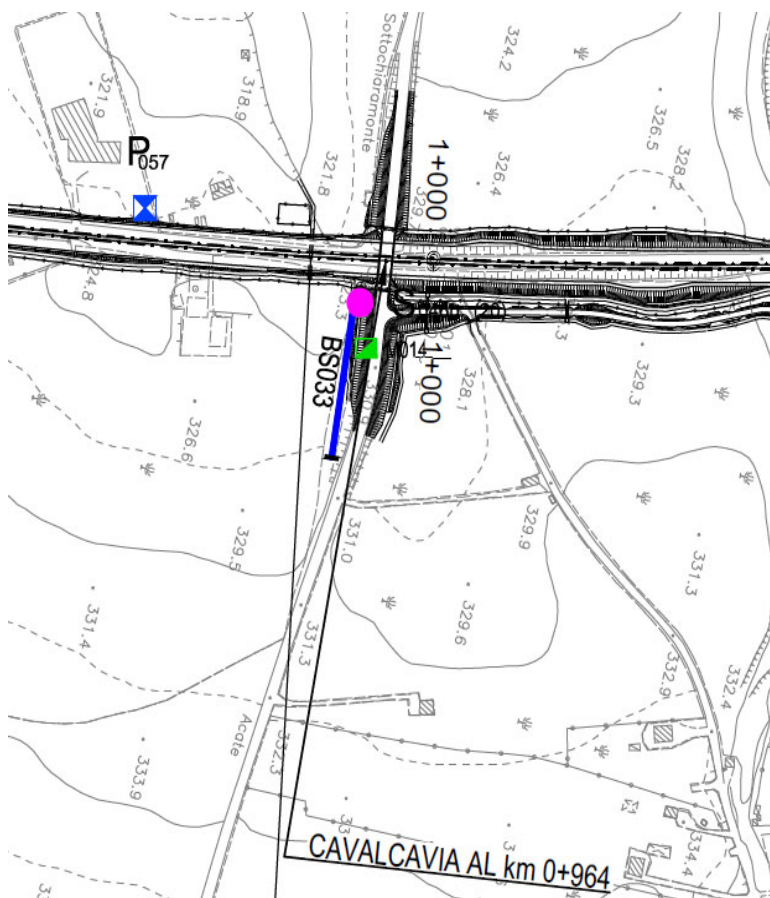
Stralcio della planimetria delle indagini per il sito di studio
